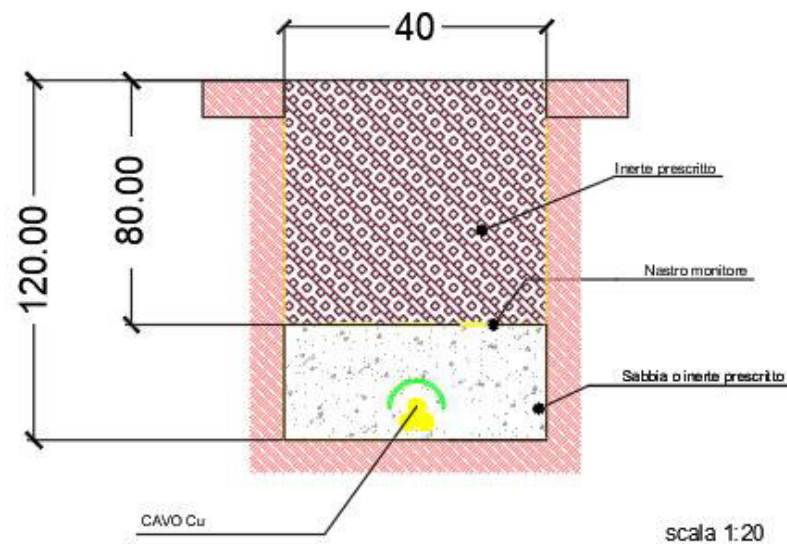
Sezione tipica di posa della linea in cavo in impianto (1 terna).
